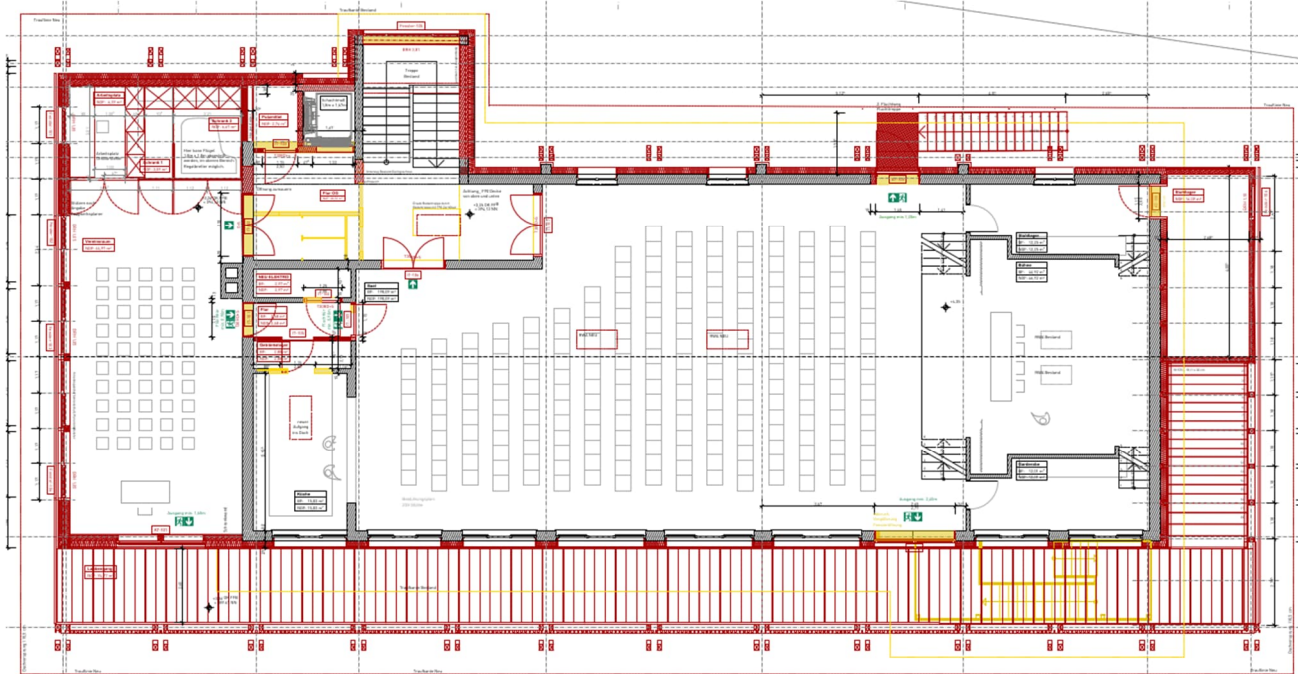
Übersicht Grundriss OG geplant
